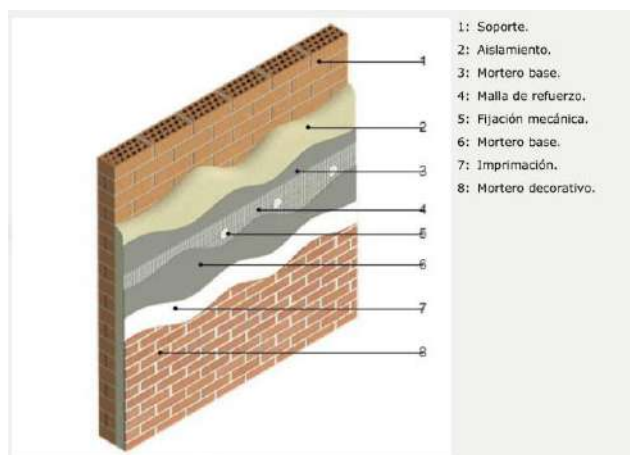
Fachada de ladrillo con aislamiento de poliestireno expandido
